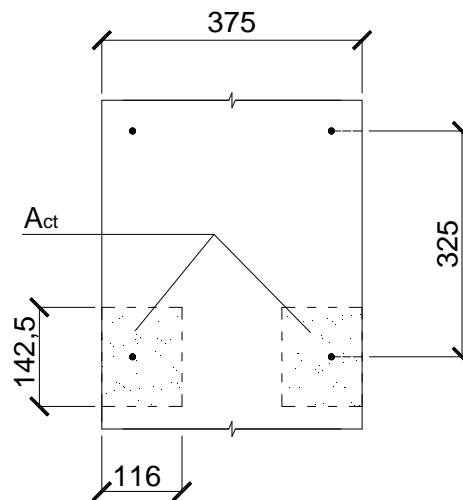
Sección longitudinal del espécimen N2-N. Detalle de las áreas efectivas de la armadura pasiva transversal, según el criterio definido en el MC 1990. Cotas en mm.
